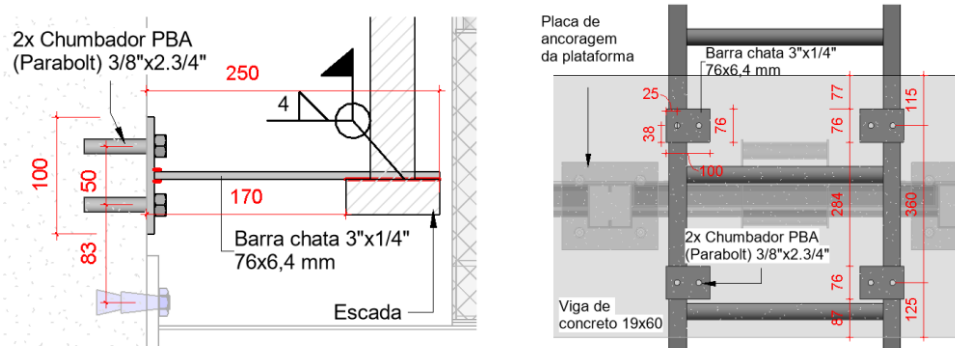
Espaçadores e fixação longitudinal das escadas tipo marinheiro
